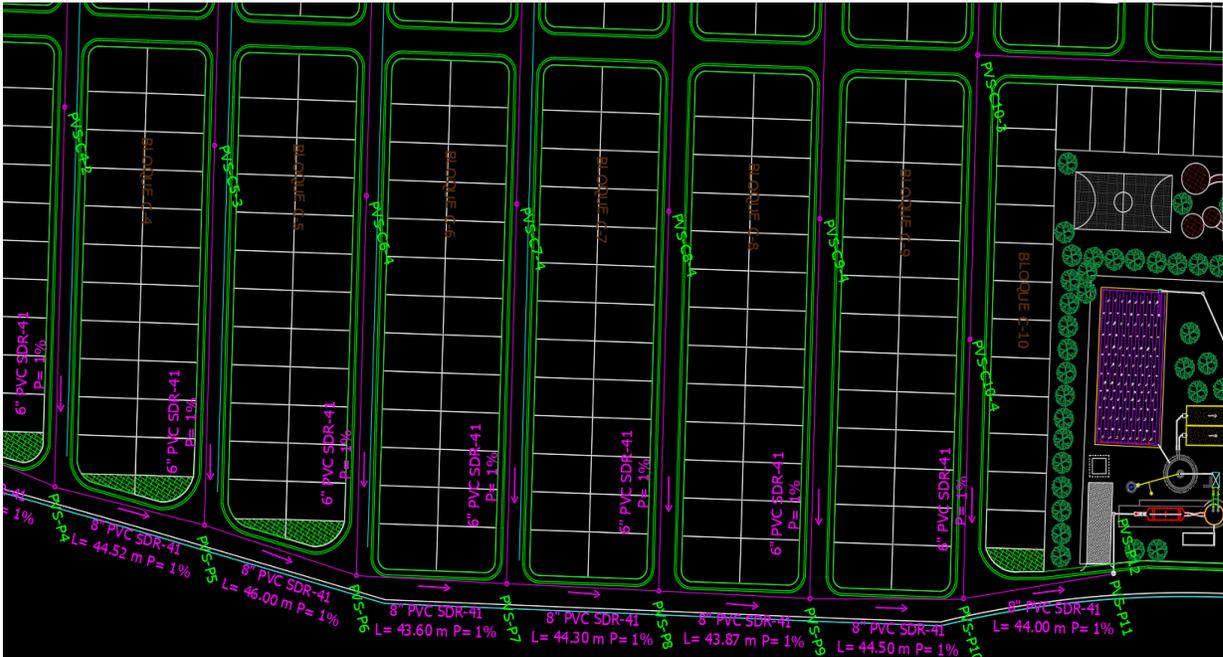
Propuesta de Sistema de Alcantarillado Sanitario de la Urbanización,
